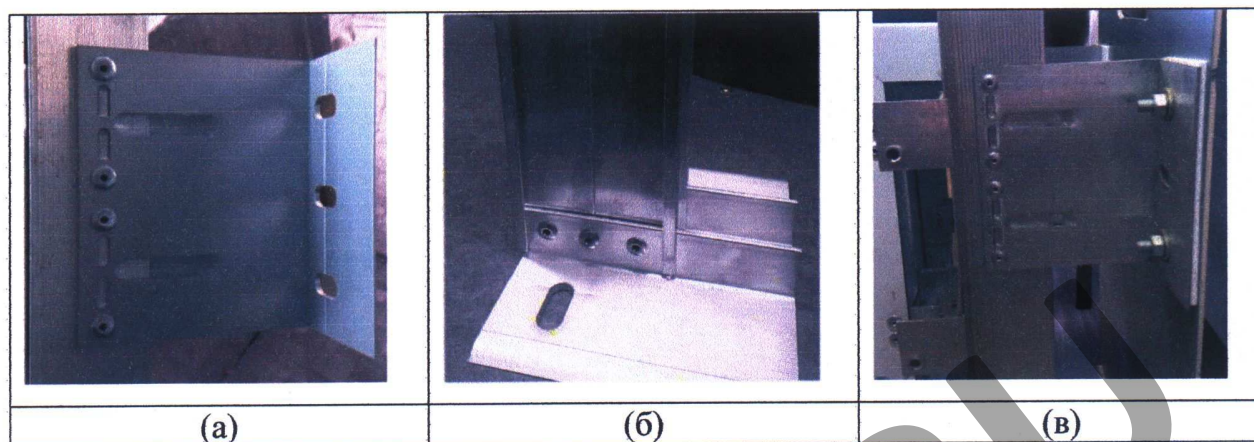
Внешний вид элементов несущих конструкций систем Doksa1
